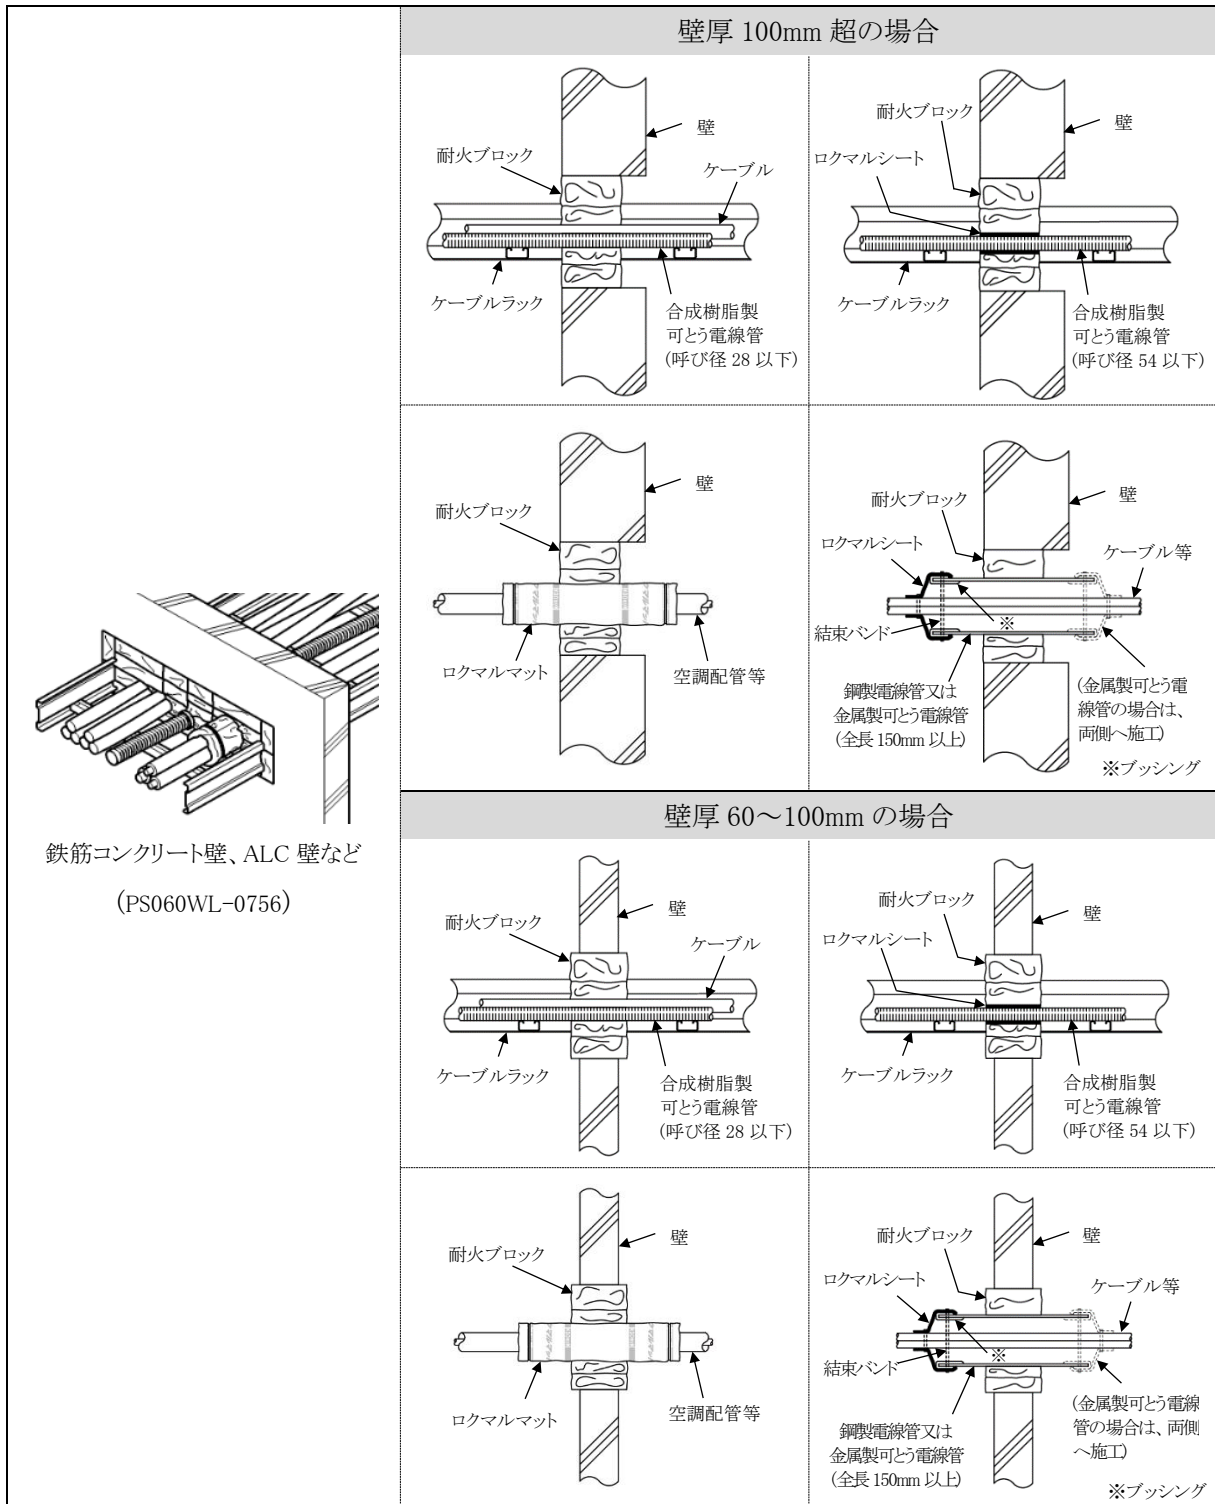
標準施工図(鉄筋コンクリート・ALC 壁などの場合)
